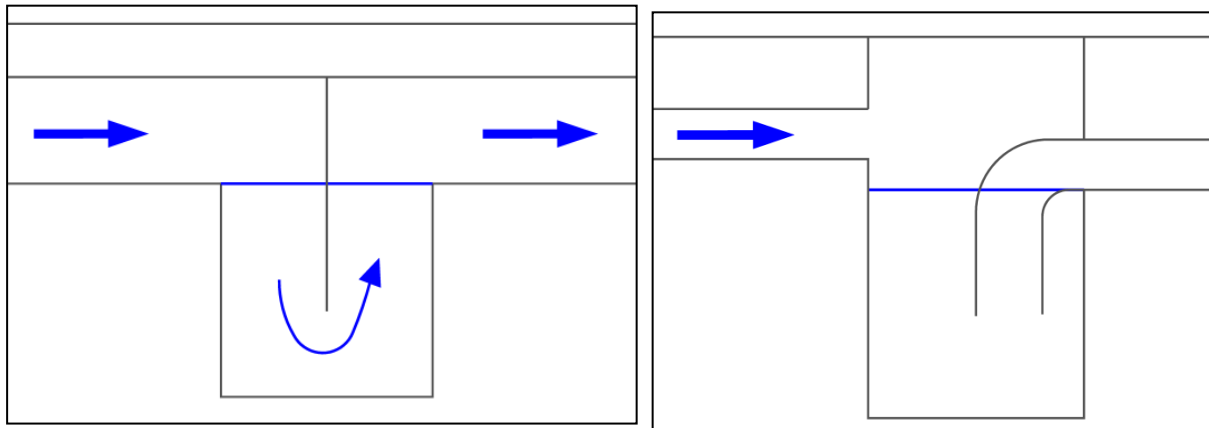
Schémas de principe de 2 exemples de zones de décantation (cloison siphonée et coude PVC)
